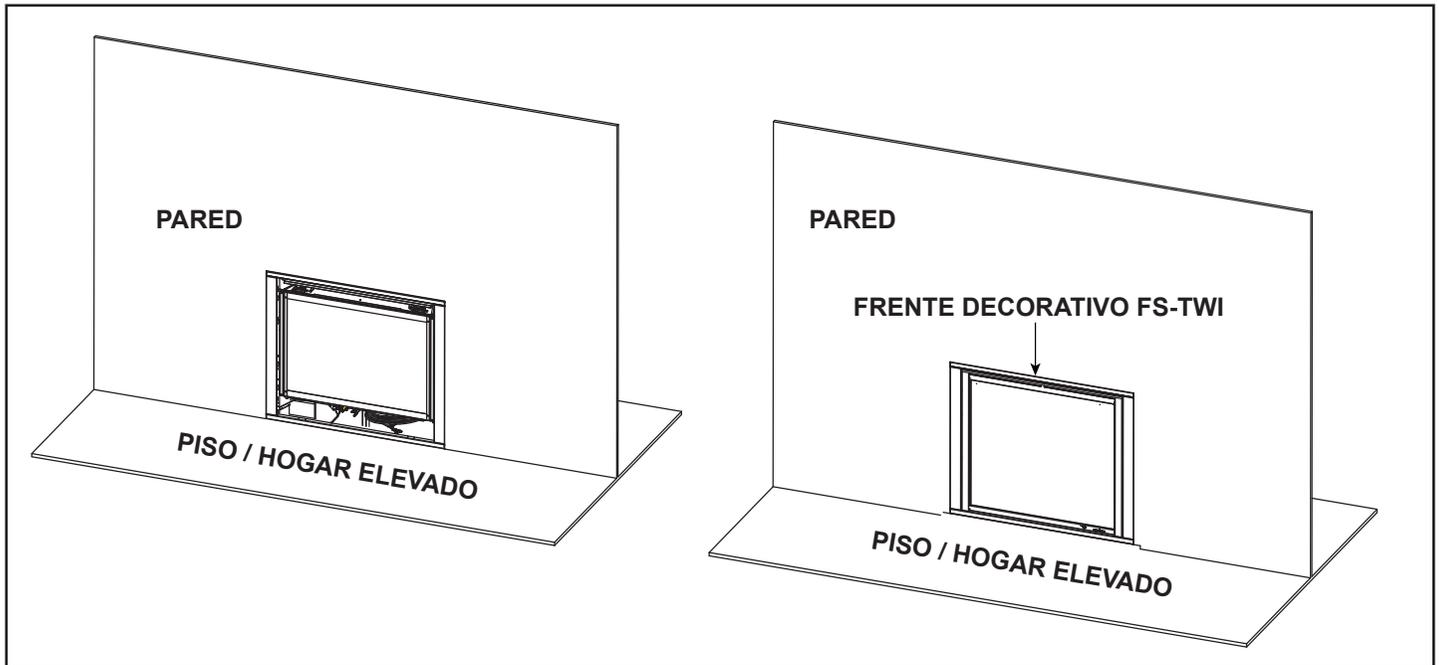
Aparato instalado en el piso o en un hogar elevado
